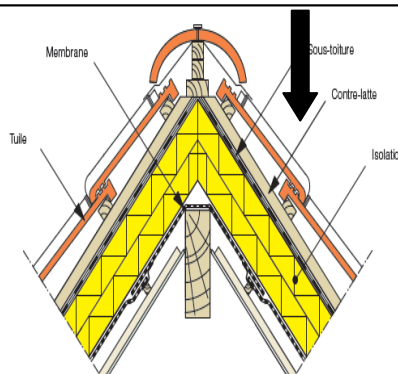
L'emplacement d'un écran sous- toiture.⁶⁹
